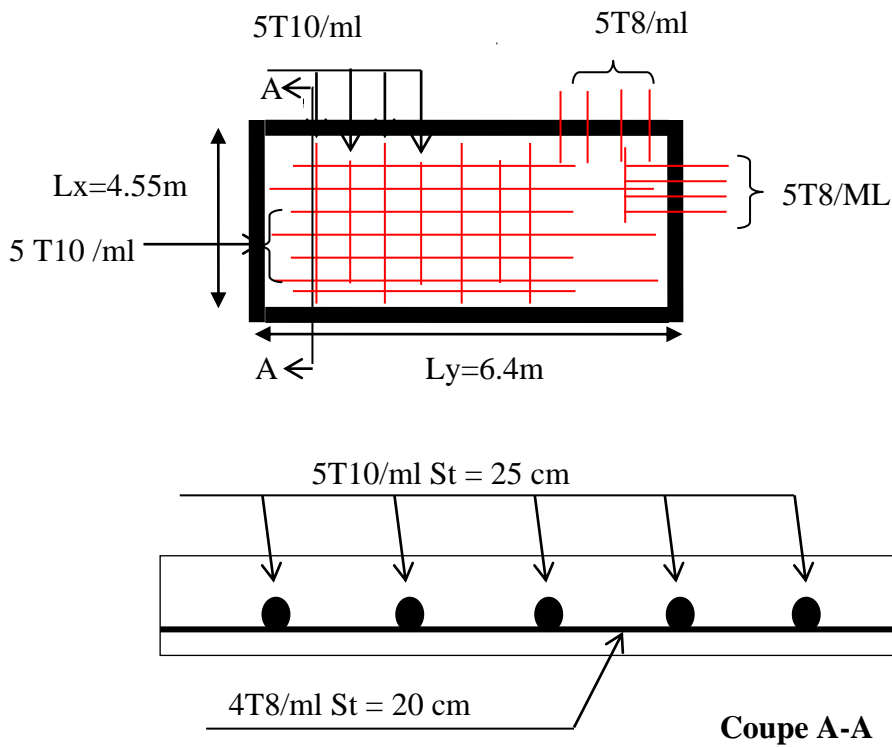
Ferrailage de la dalle pleine sur 04 appuis (D3).
